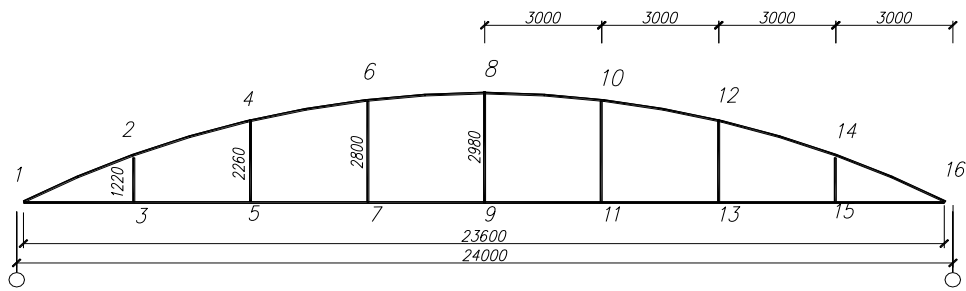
Геометрическая схема безраскосной фермы
